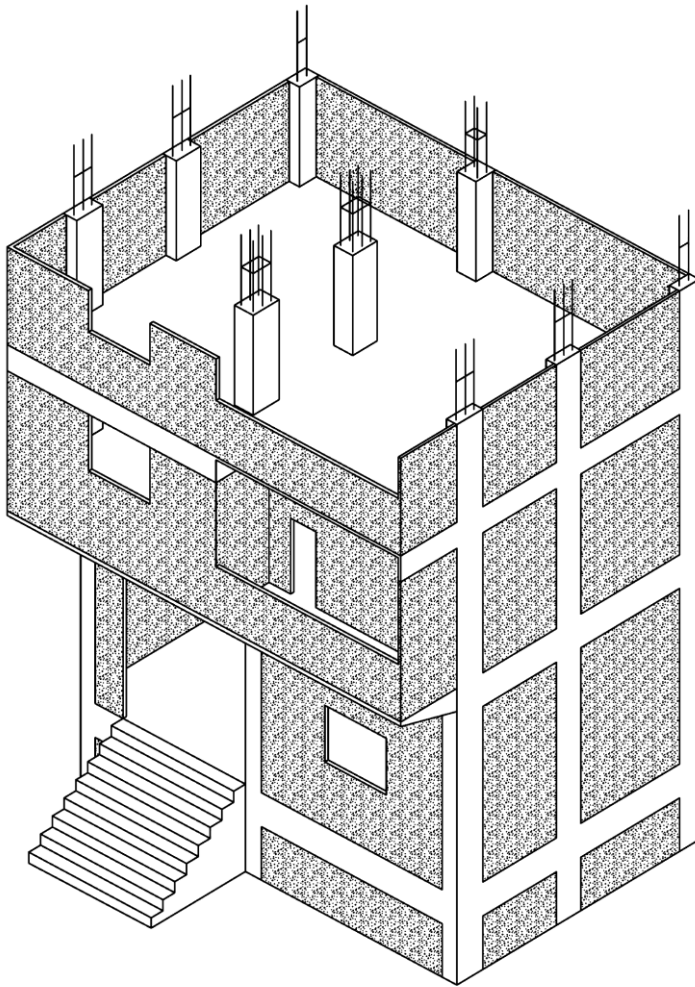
3_004: Typische Stahlbeton-Skelettkonstruktion eines mehrgeschossigen Wohnhauses in Ägypten, Darstellung des Autors nach: [Angélie et al., 2016]
